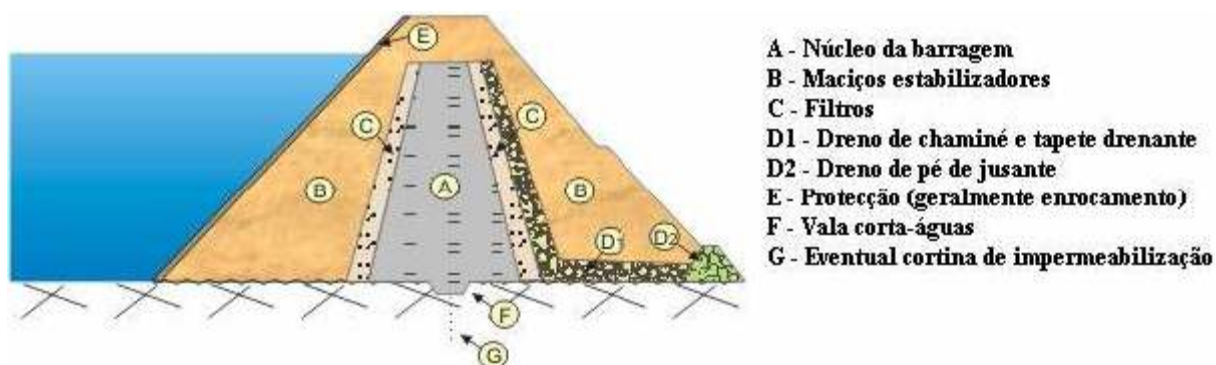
Barragens de aterro de terra com perfil zonado [6]
